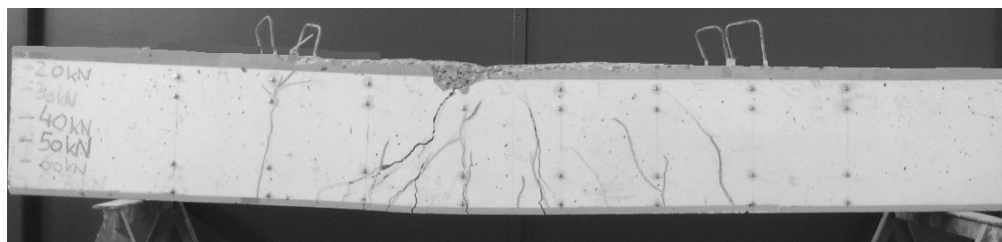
Faciès de fissuration de la poutre ADHAP.
